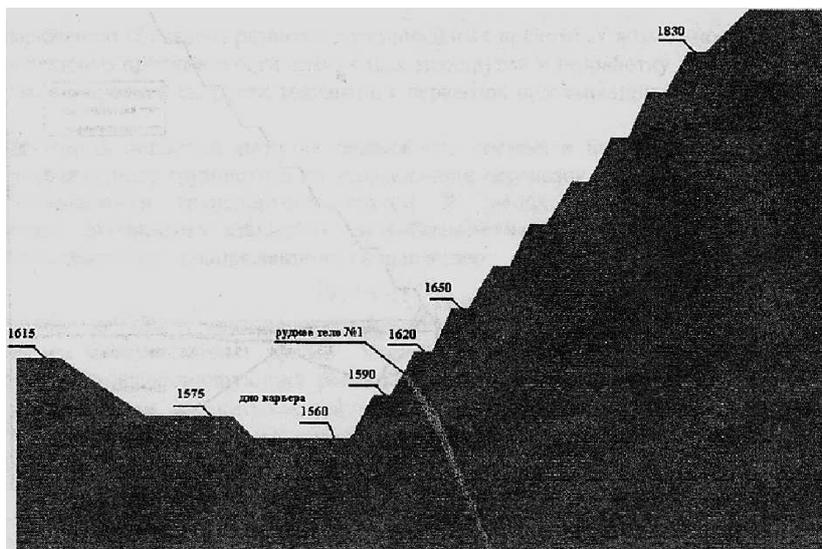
Проекция на вертикальную плоскость на момент завершения открытых горных работ на карьере
